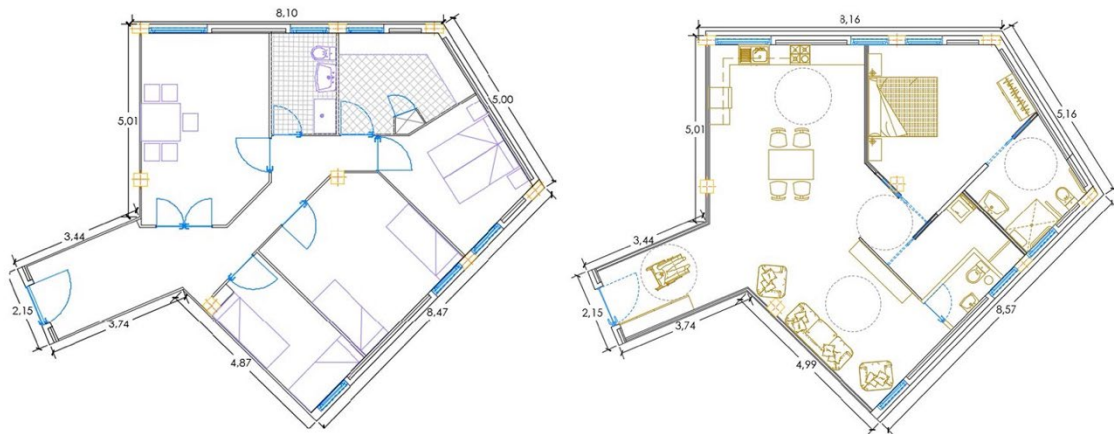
Planta del estado actual de una vivienda tipo. Planta propuesta de vivienda adaptada
